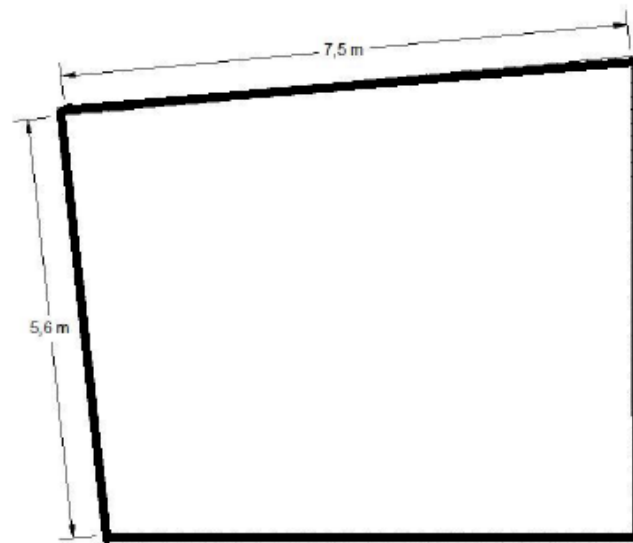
Planta esquemática da câmara reverberante R1 do laboratório de Acústica da FEUP
